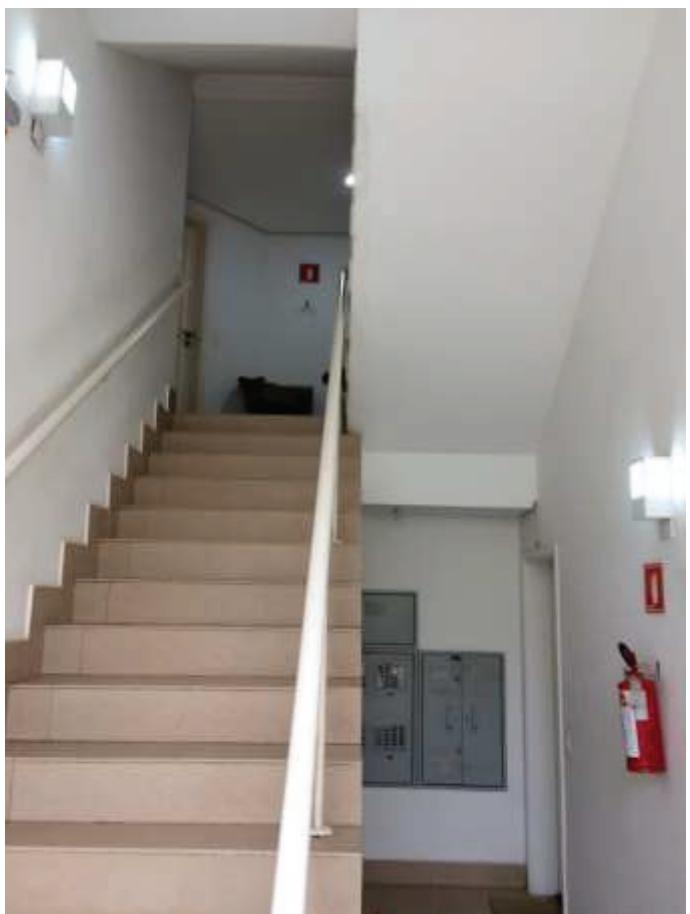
Hall e escada de acesso ao pavimento superior - Fonte: Autor
